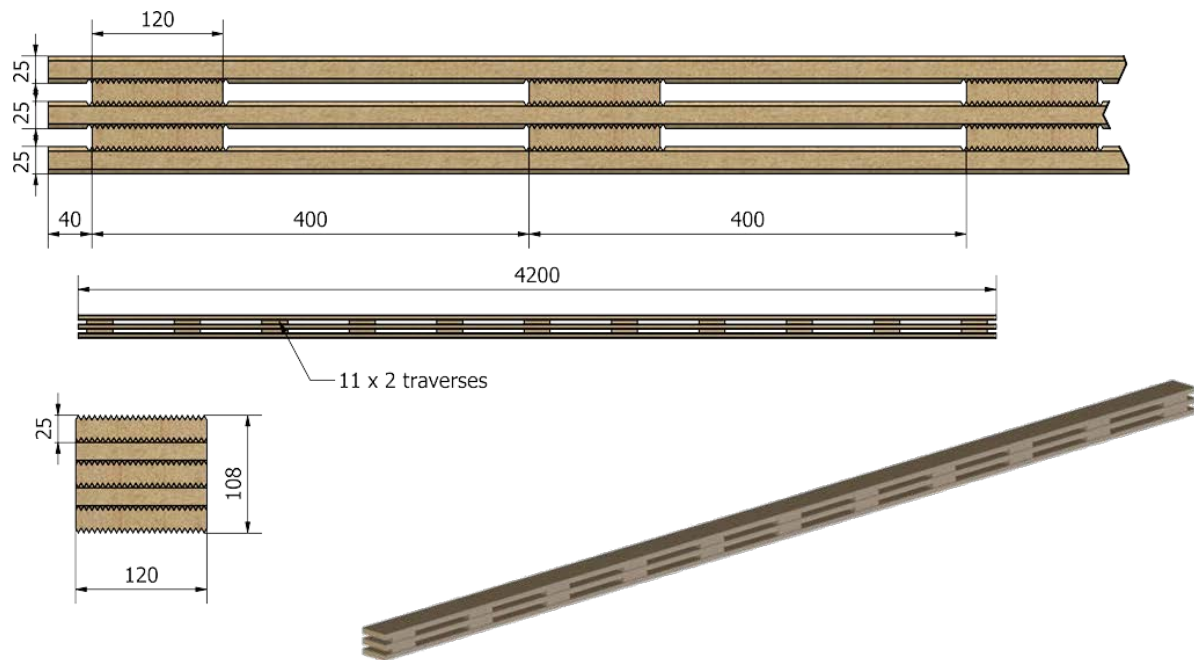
Plan de fabrication d'une poutre ajourée
